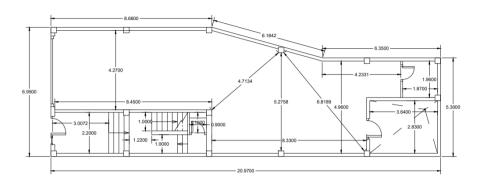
Plano de cotas estado actual. Fuente: Propia
